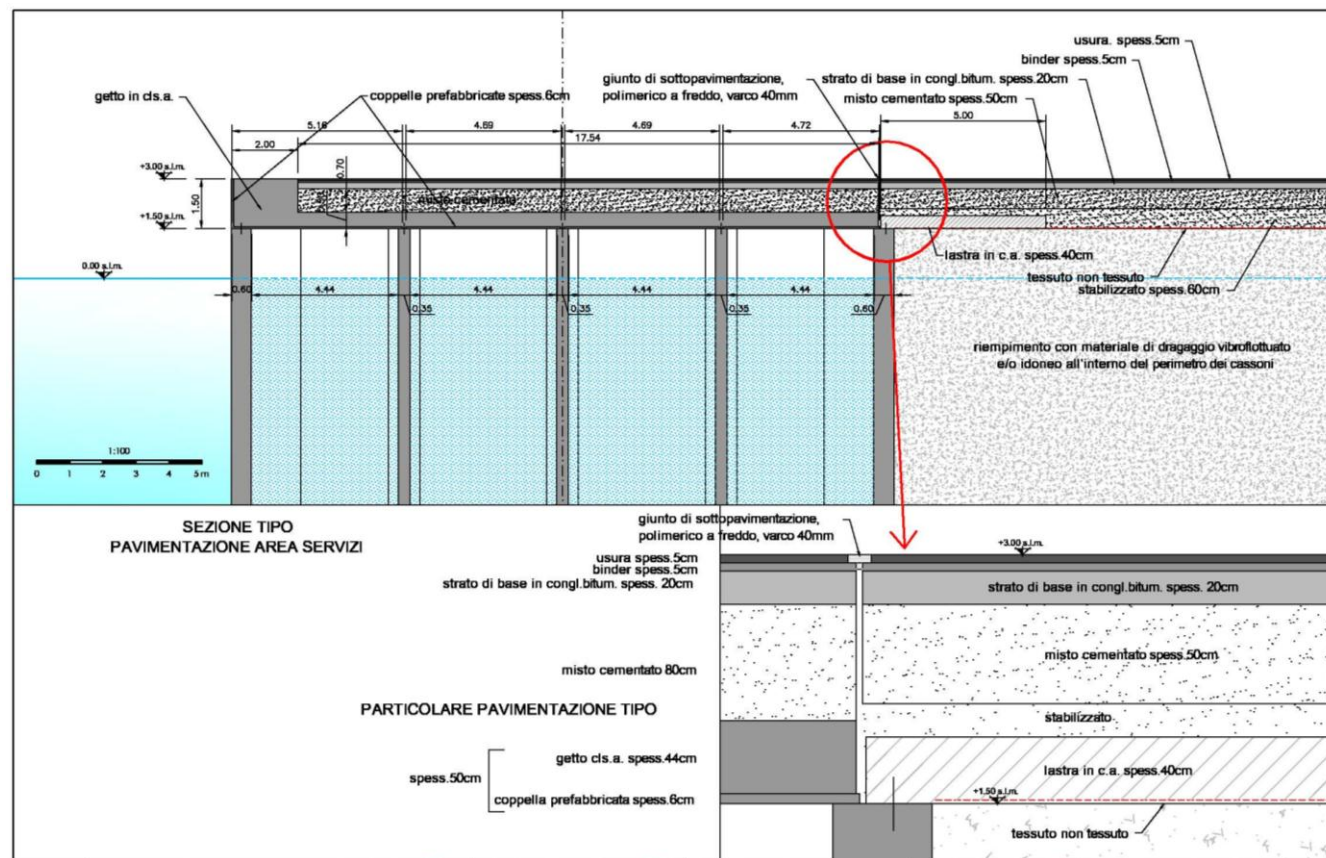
Banchina servizi - sezione tipo delle pavimentazioni
